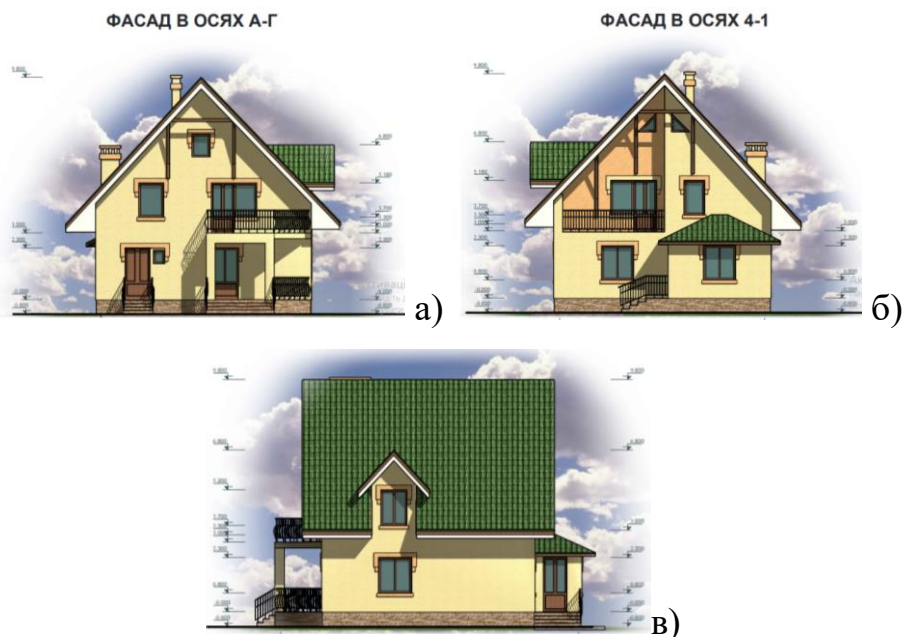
а) Фасад в осях А-Г; б) Фасад в осях 6-1; в) Фасад в осях 2-1
